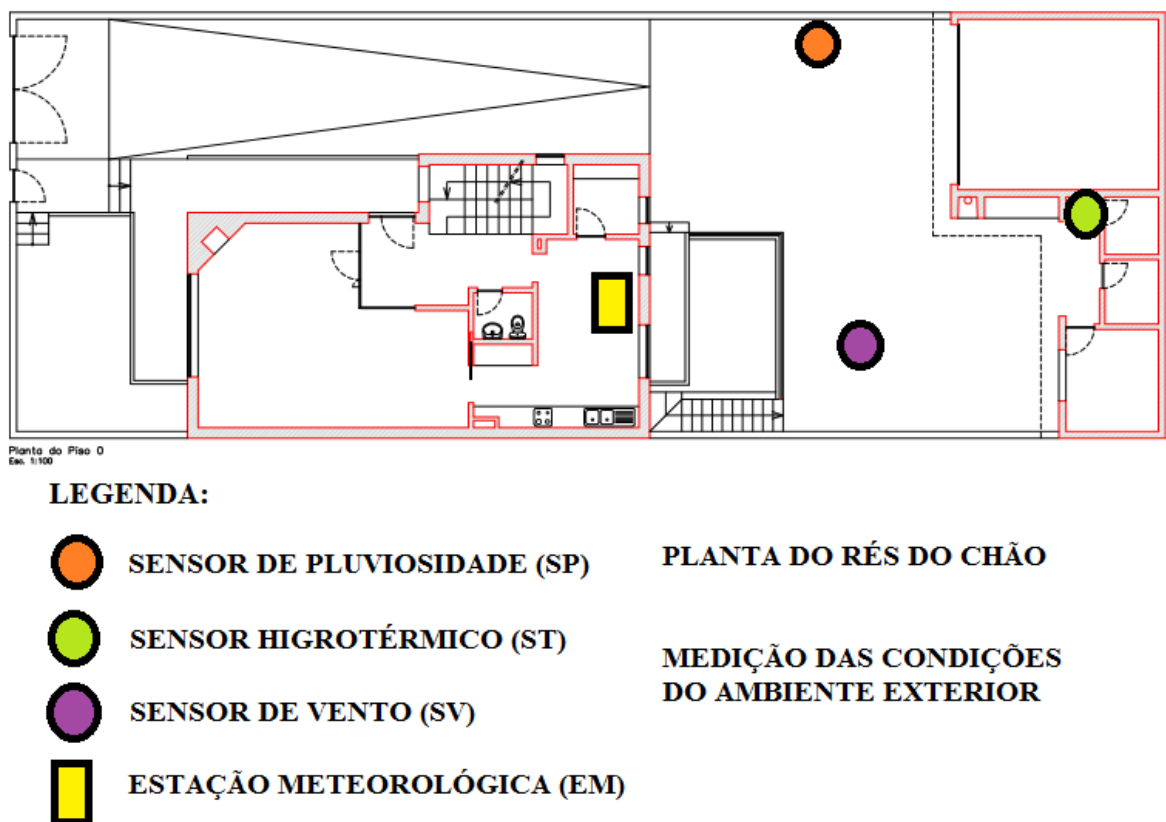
Planta com a posição da colocação do equipamento de medição do ambiente exterior
